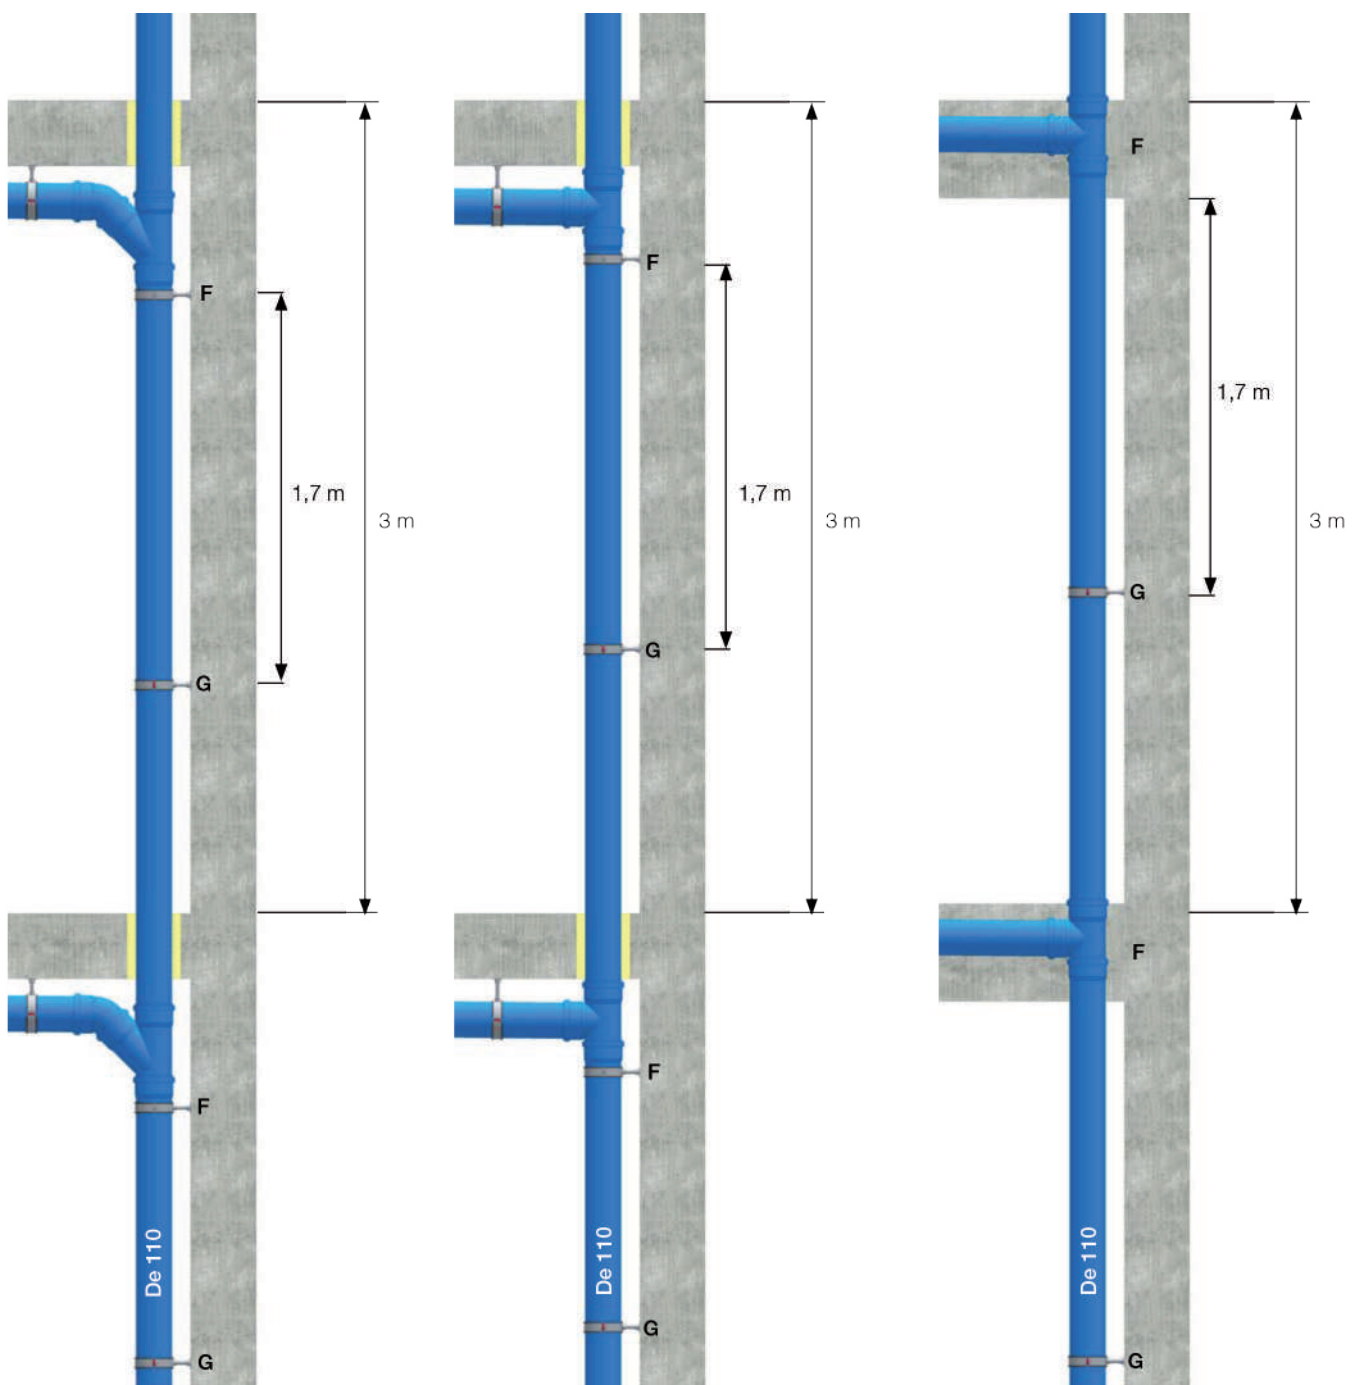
Puntos de anclaje en tuberías verticales o sujeción en la colada de la tubería vertical.
